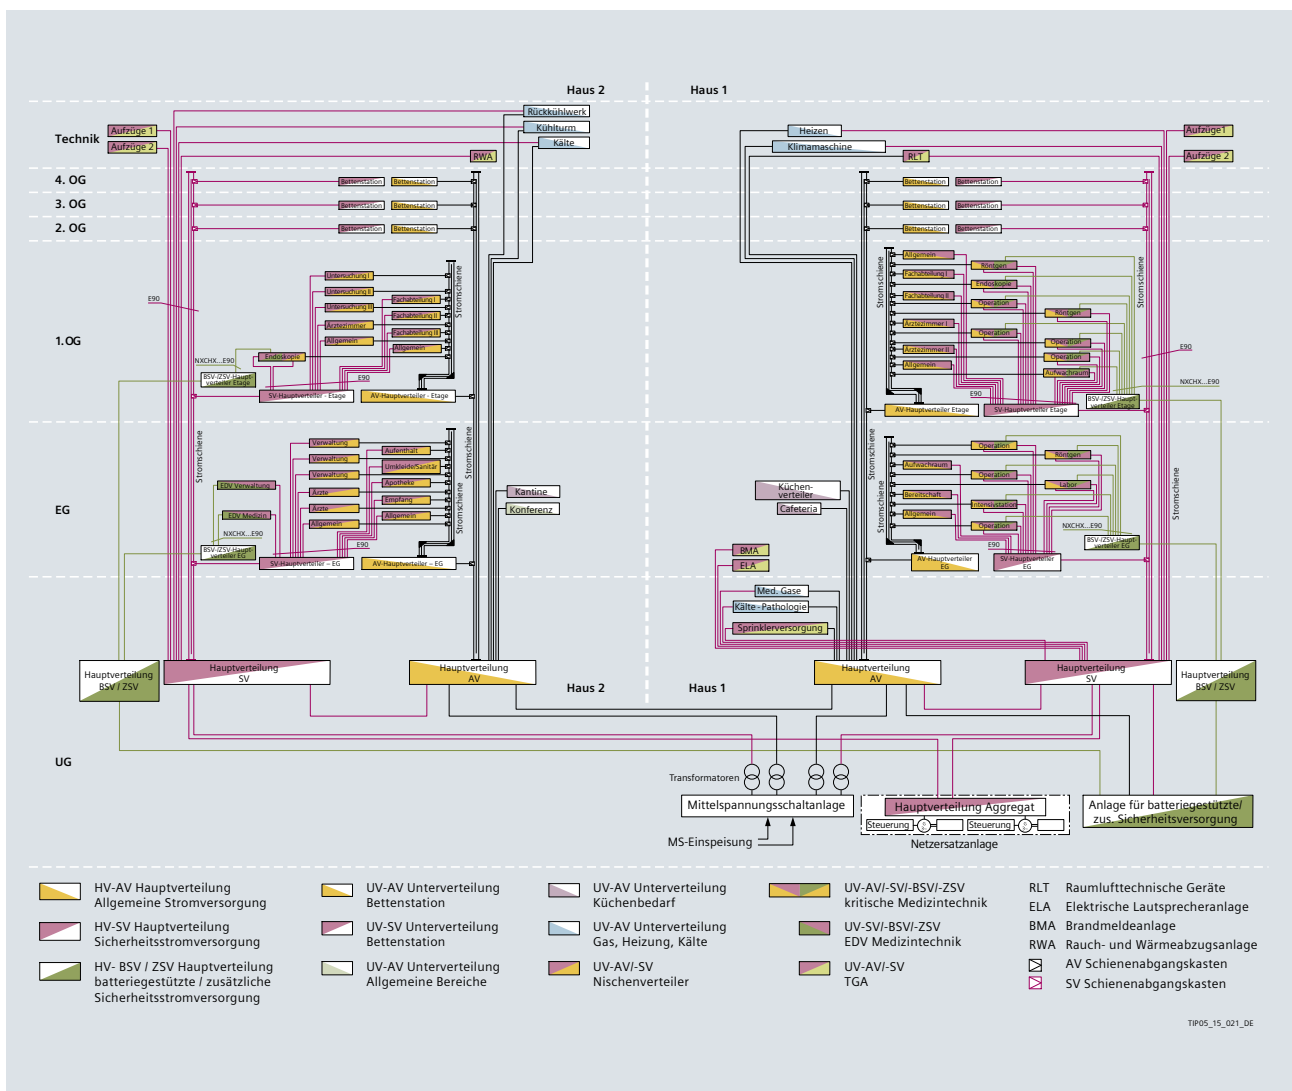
/1: Strangschema für ein Krankenhaus mit zwei benachbarten Gebäuden
